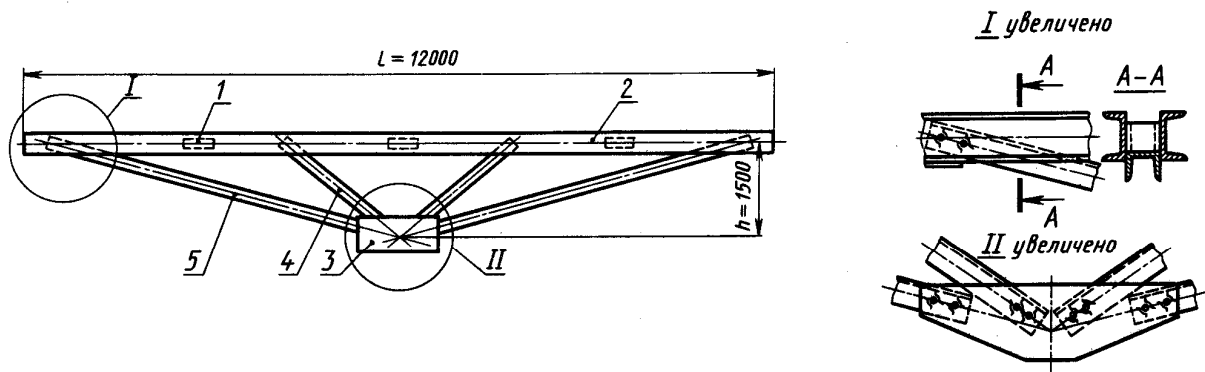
Стропильная ферма, свариваемая точечной контактной сваркой
